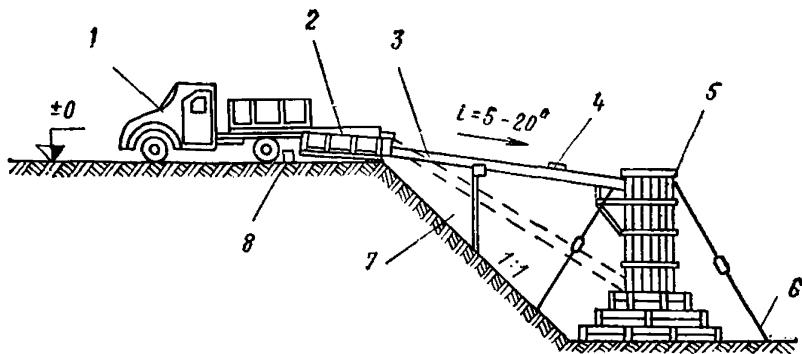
Схема бетонирования фундамента с помощью виброконвейера
